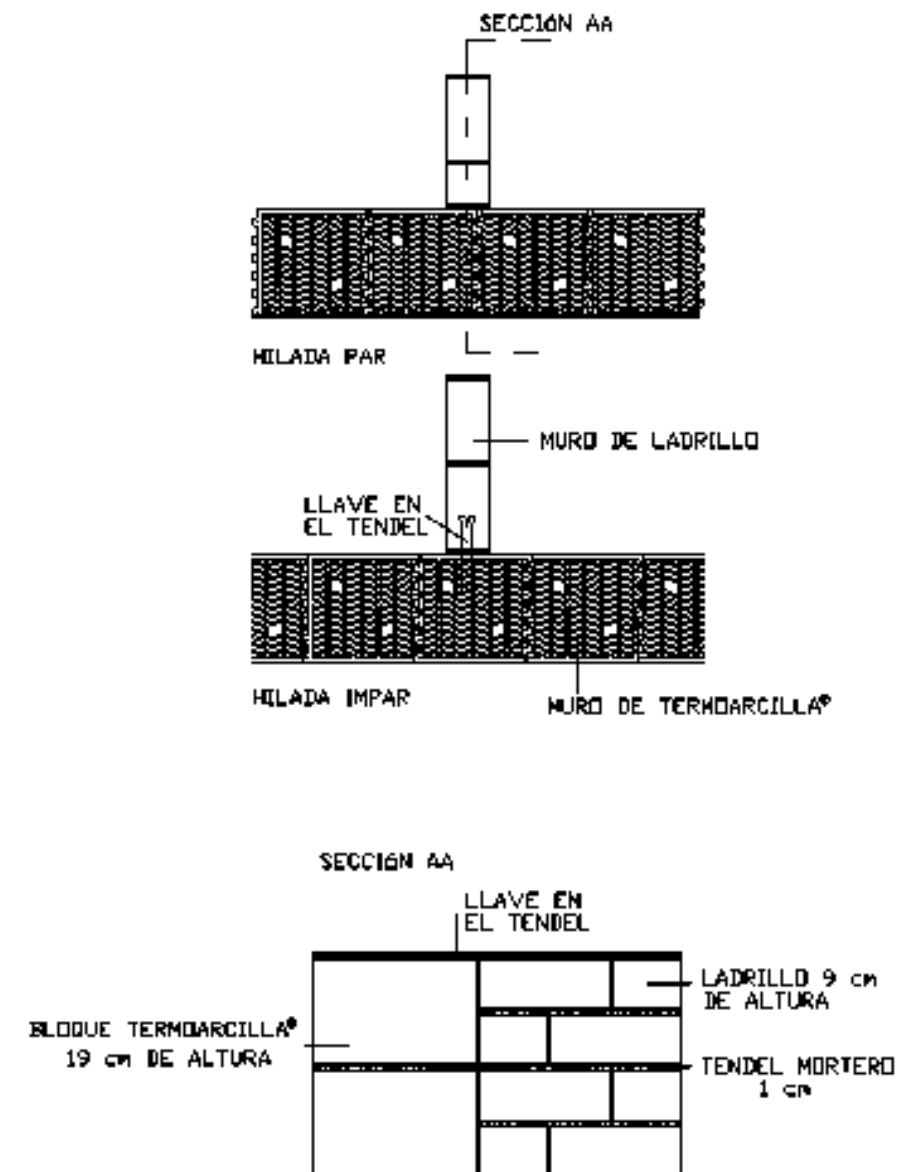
Enlace de muro de ladrillo con muro de Termoarcilla®.
